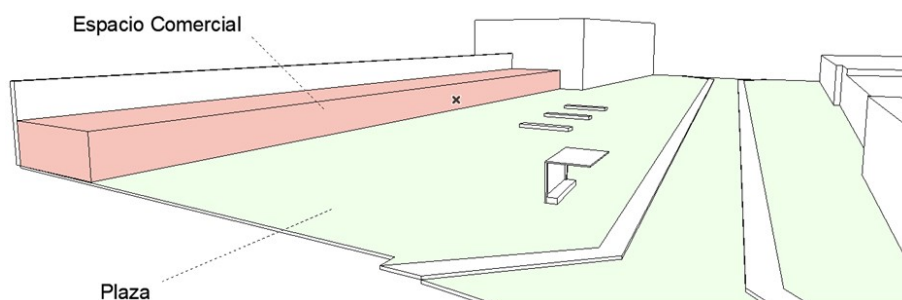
Espacio comercial y plaza. Fuente y elaboración: Autores
